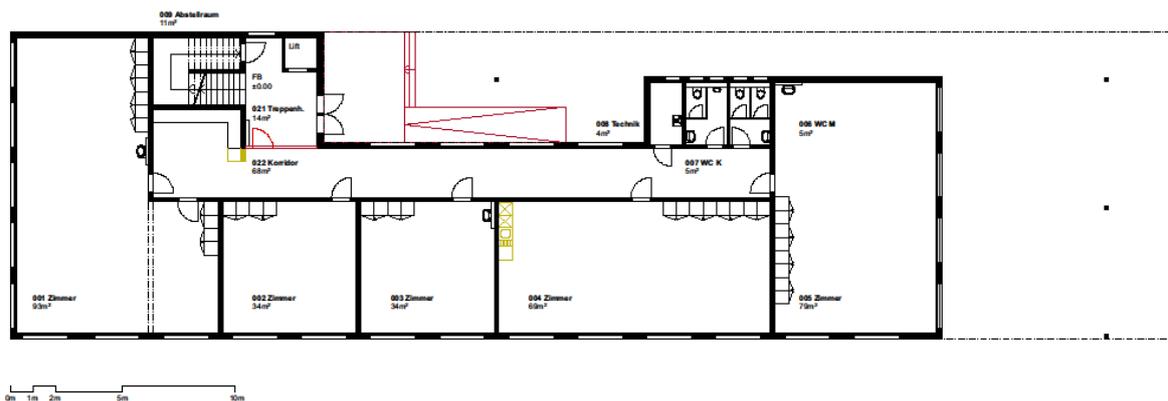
Grundriss Erdgeschoss bestehendes Schulraumprovisorium
